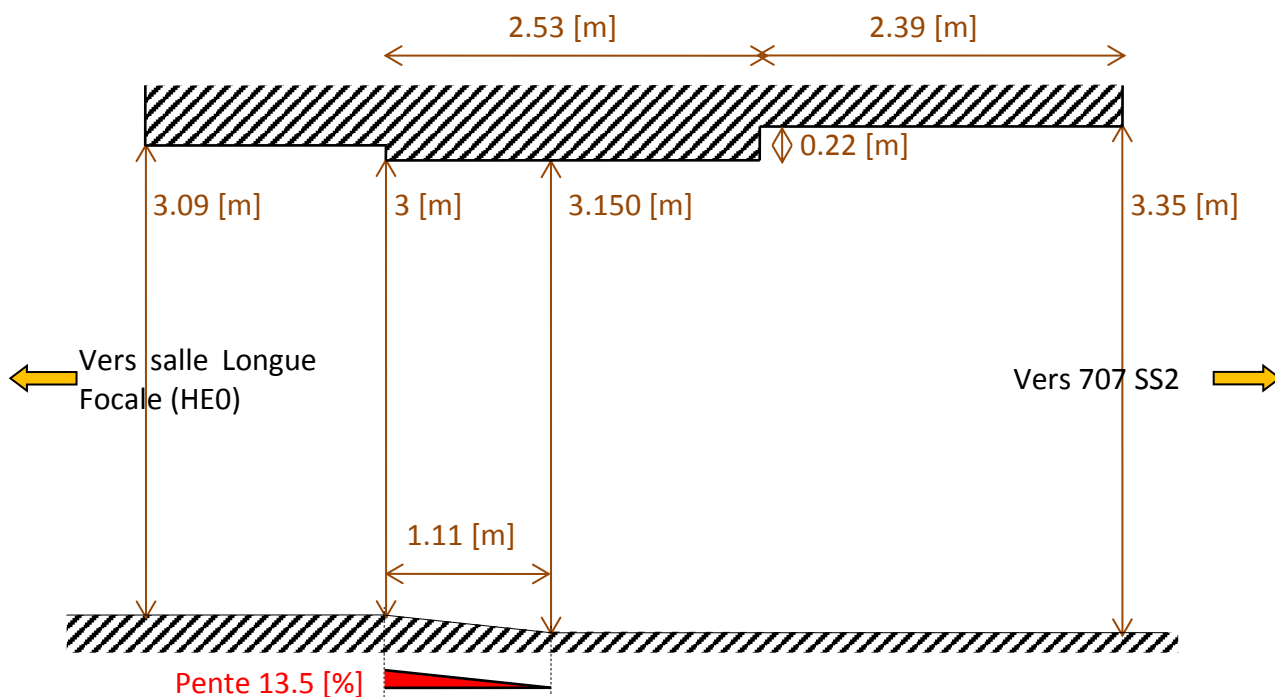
Vue en coupe (élévation) de la rampe d'accès vers la Longue Focale (HE0).
